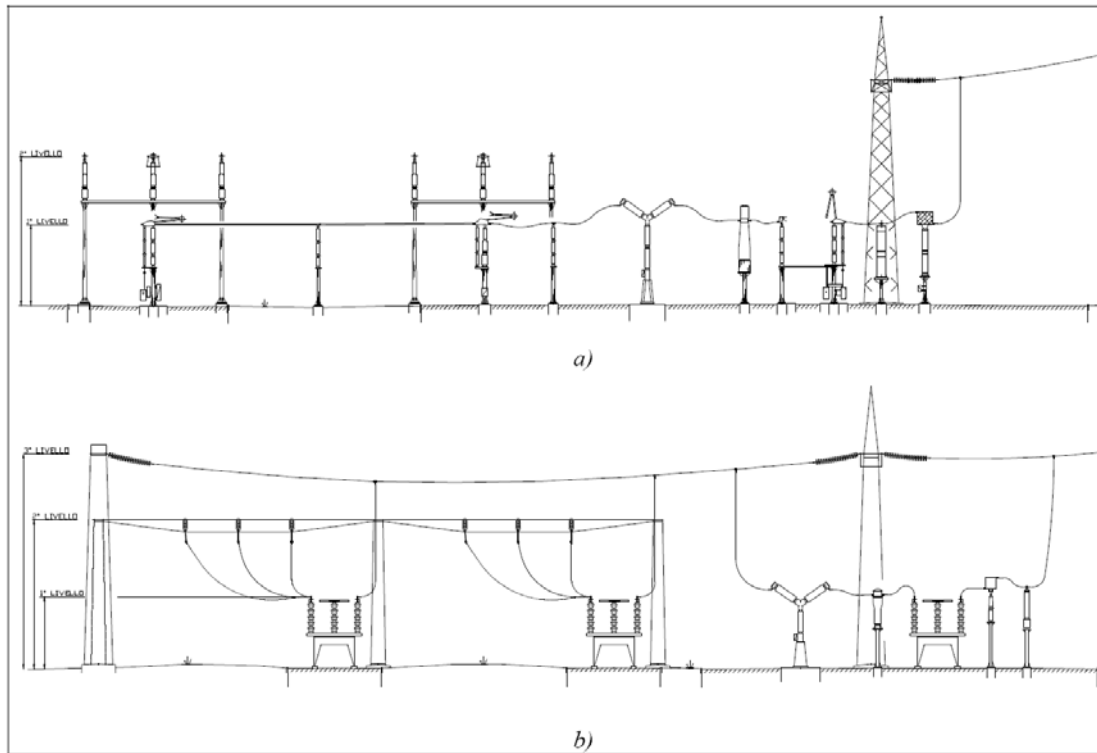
Layout del doppio sistema di sbarre realizzato con conduttori rigidi (a) e flessibili (b).
